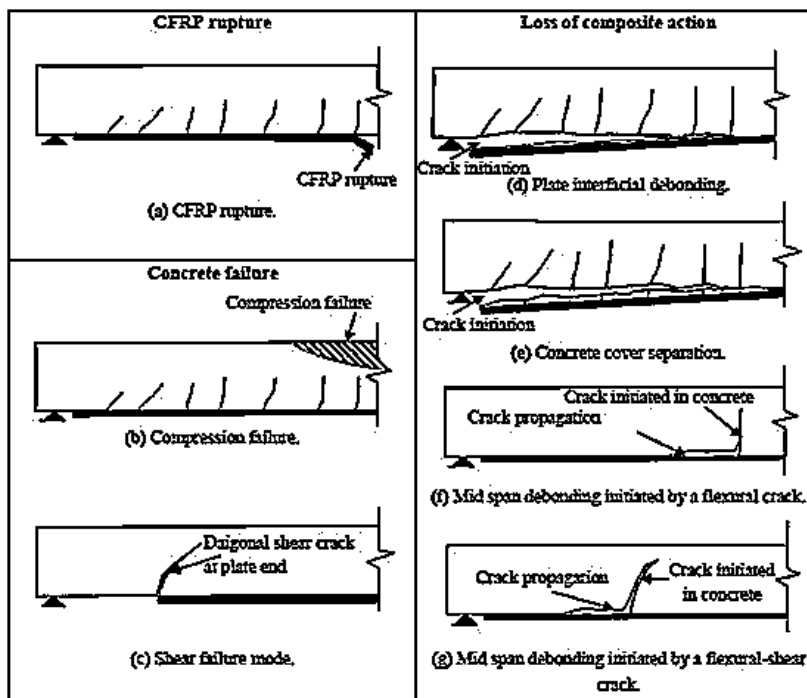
Modos de falla de vigas de concreto reforzado con reforzamiento de FRP a flexión (Yasmeen Taleb Obaidat, 2011).
